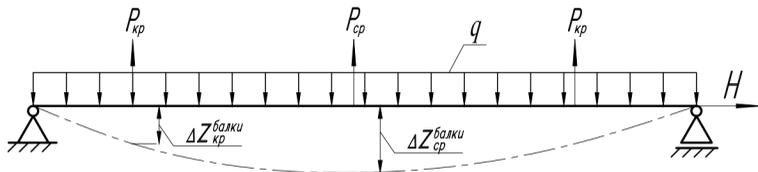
Расчетная схема к определению перемещения точек крепления подвесок к балке
